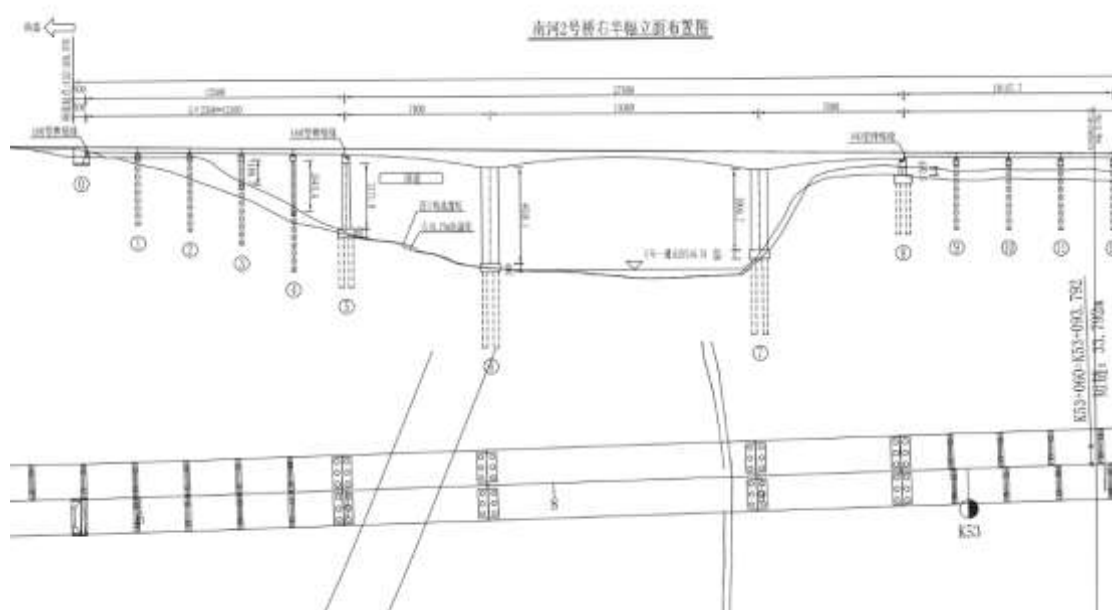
南河二号特大桥（右幅）立面布置图
